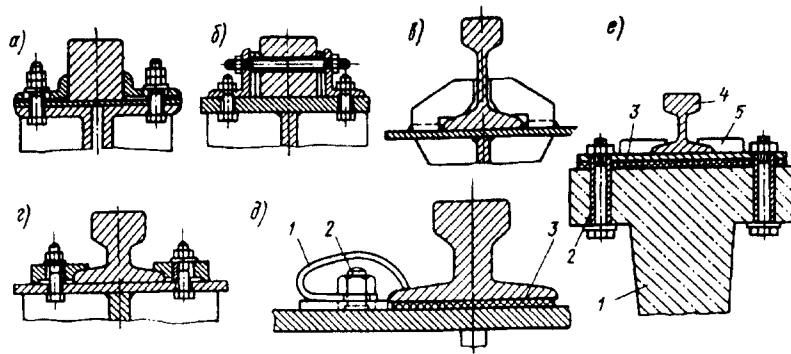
Крепление рельса к металлическим подкрановым балкам:
